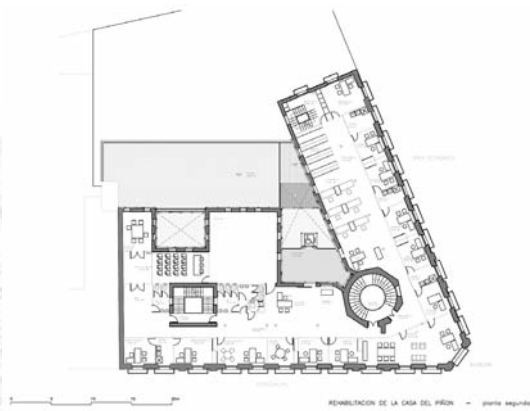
Plano de proyecto con la distribución de la planta segunda.
